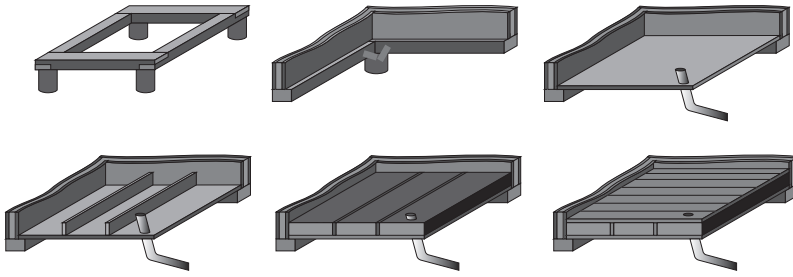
Настиление теплого пола на столбчатый фундамент
